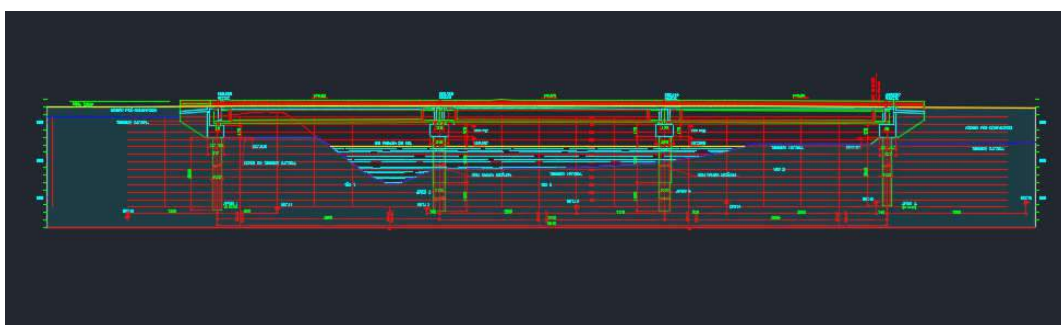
Projeto Executivo Estrutural da Nova Ponte – Elevação Longitudinal
